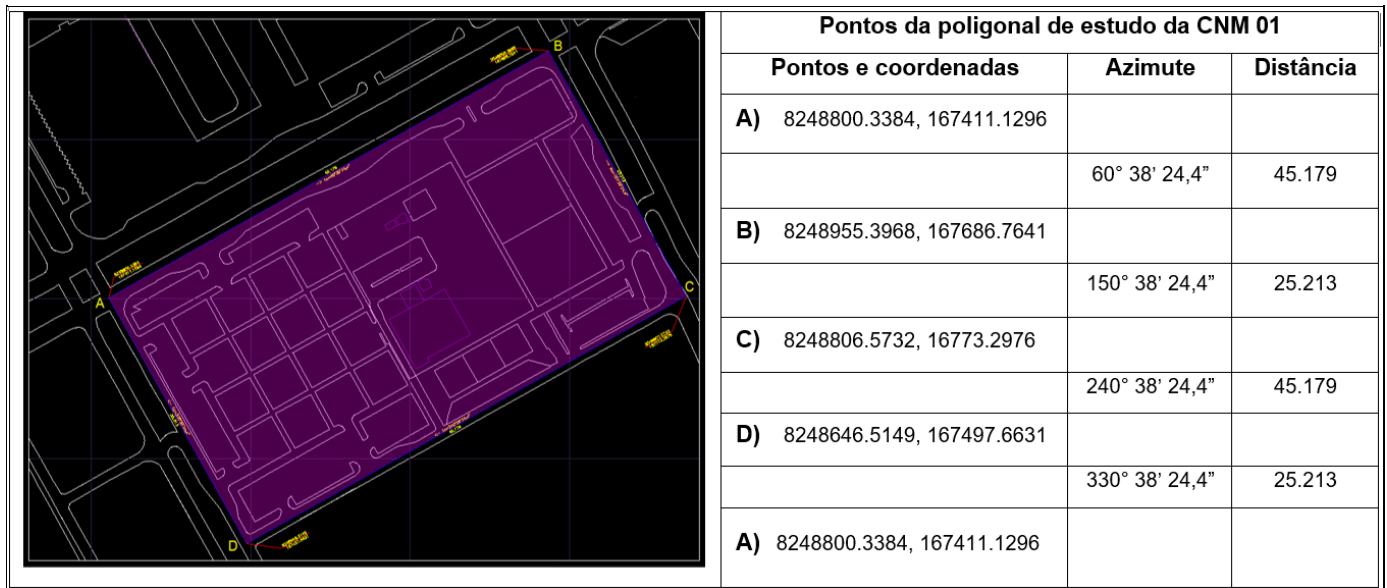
poligonal sugerida para a elaboração de projeto de urbanismo da CNM 01, montagem da DIOEST sobre planta SICAD/SEDUH
